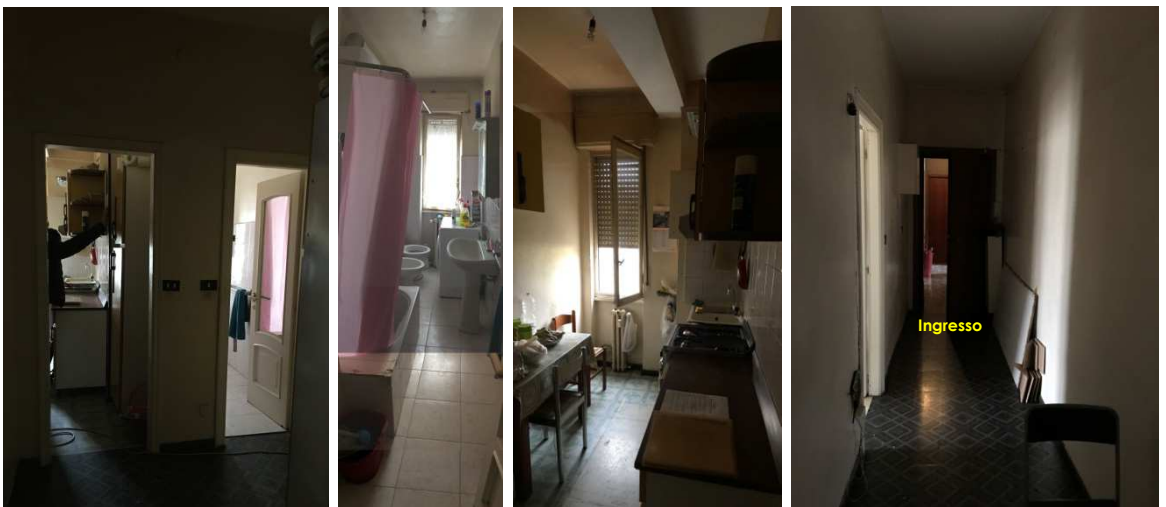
Piano Secondo. Bagno e cucina
